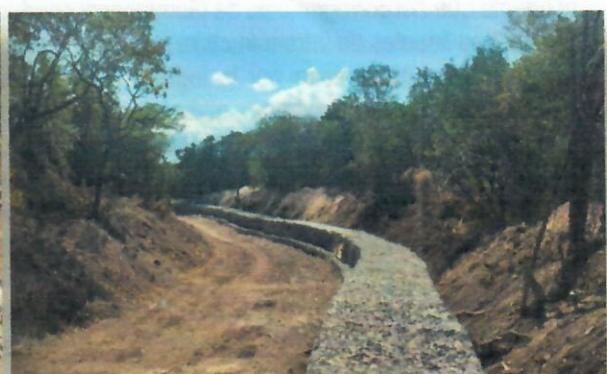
Material forestal intervenido por maquinaria para la construcción de gaviones, punto 27 Arroyo Pozo Hondo
